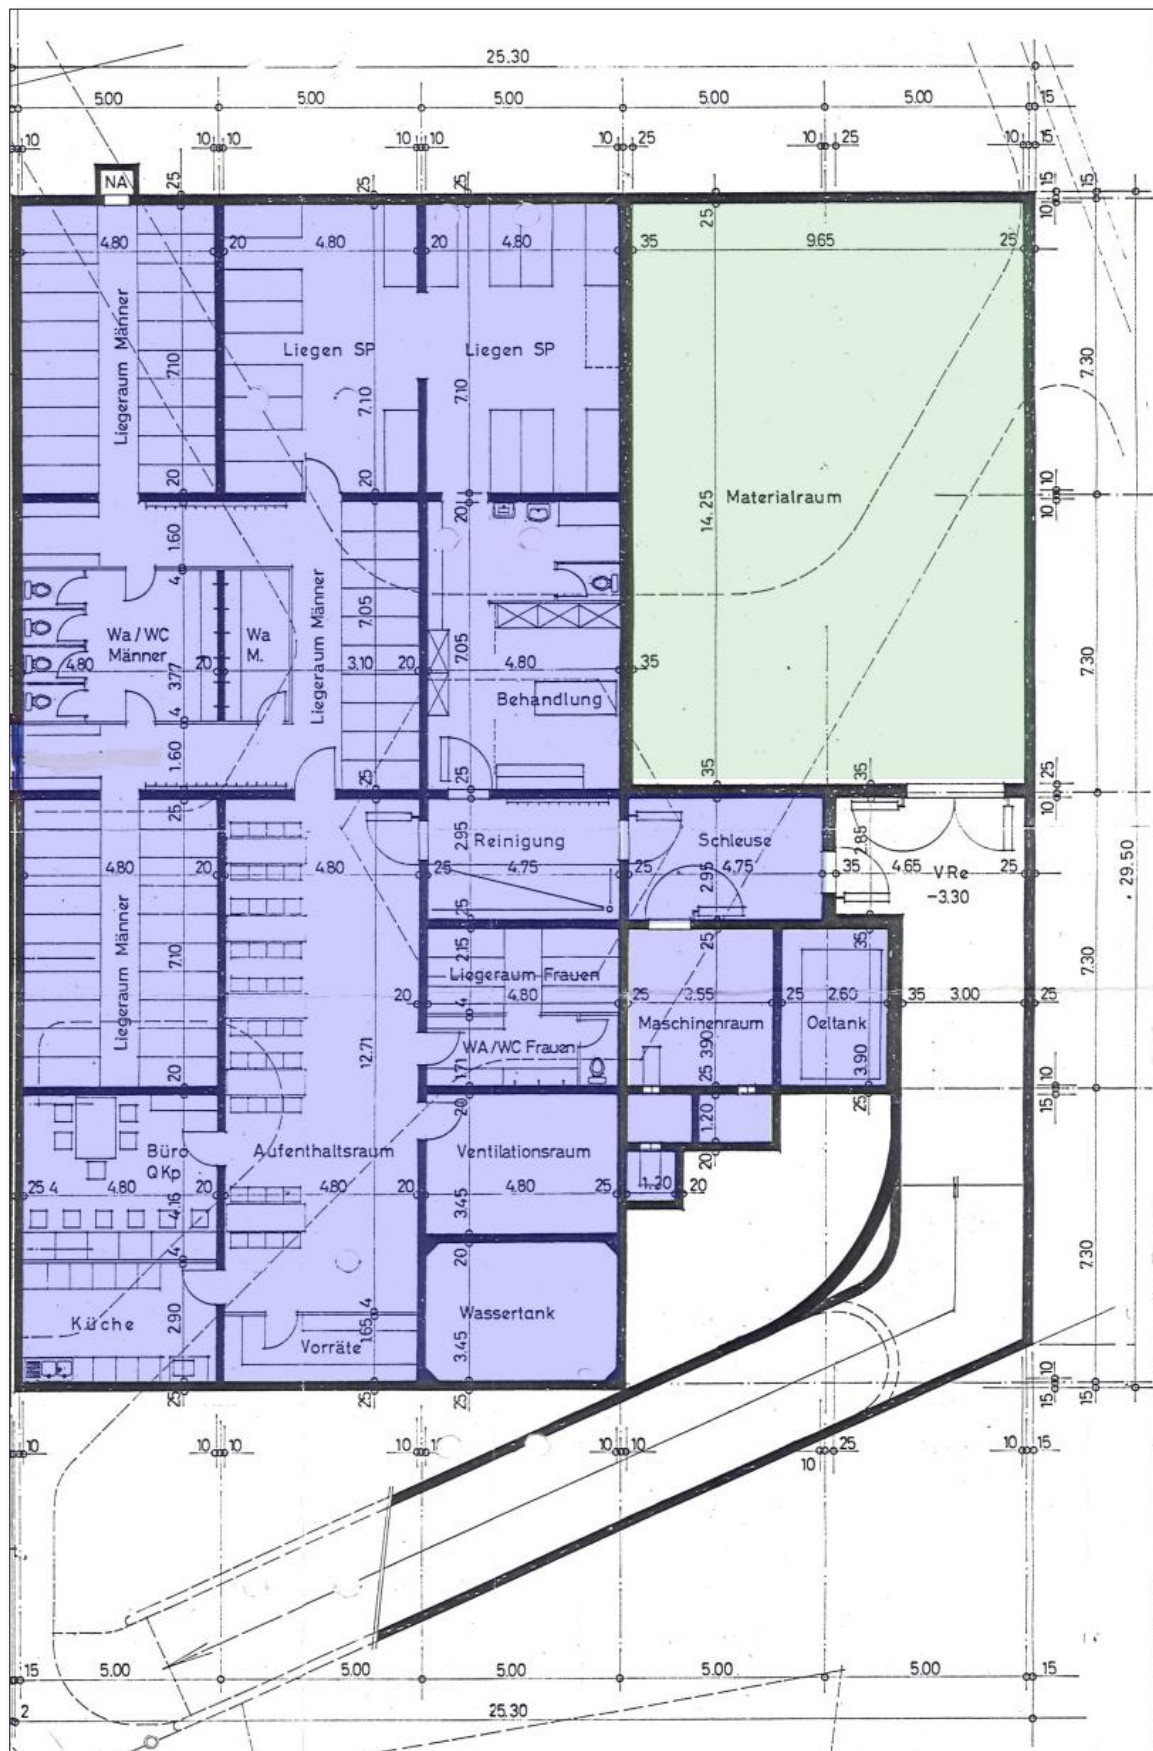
Grundriss BSA Bifang, ohne Massstab
